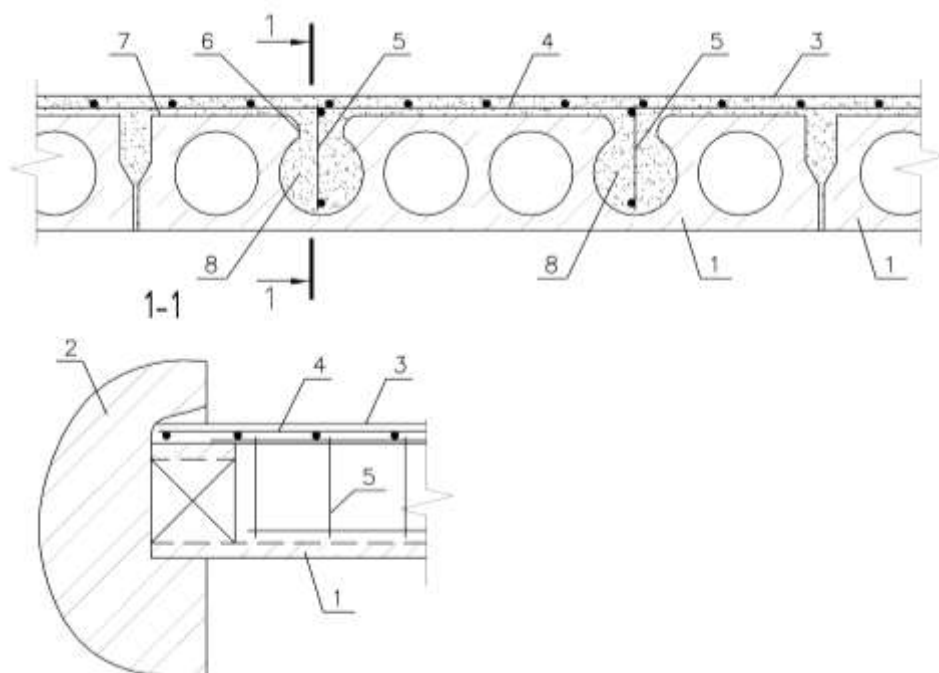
Нарастивание плит сверху при недостаточном сцеплении поверхностей 1- усиливаемая плита; 2- кирпичная стена; 3- монолитный слой бетона; 4- арматурная сетка; 5- арматурные каркасы
